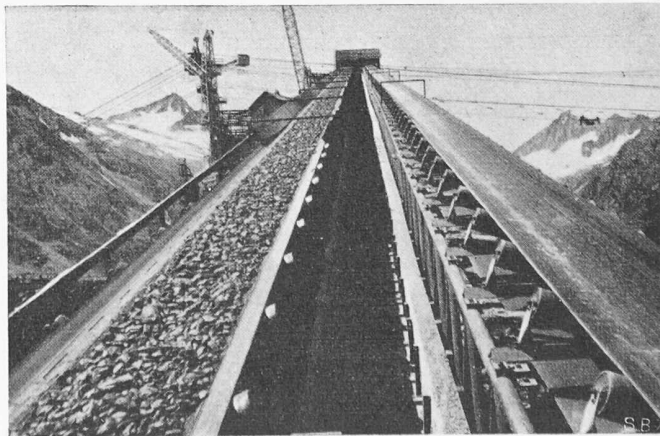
Draufsicht auf die fertige Brücke mit den beiden Transportbändern
